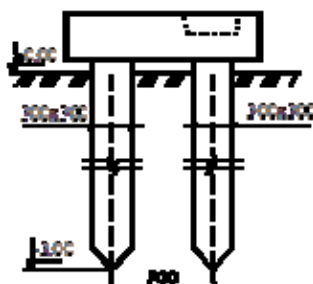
Фундамент с двумя сваями и сборным железобетонным ростверком
